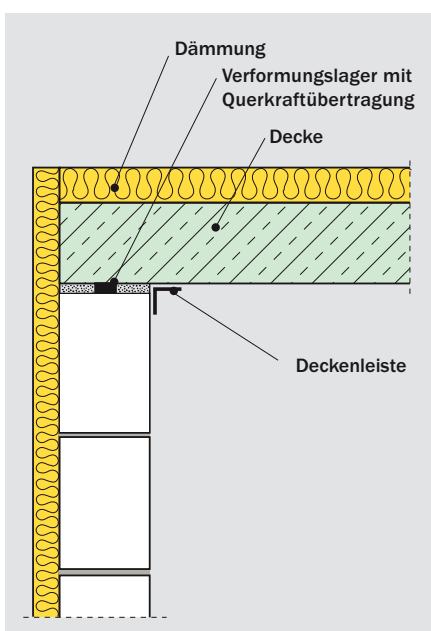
Konstruktive Maßnahmen zur Zentrierung der Deckenauflagerkraft am Beispiel der Außenwand unter einer Dachdecke – Verformungslager mit Zentrierstreifen zwischen Wand und Decke
